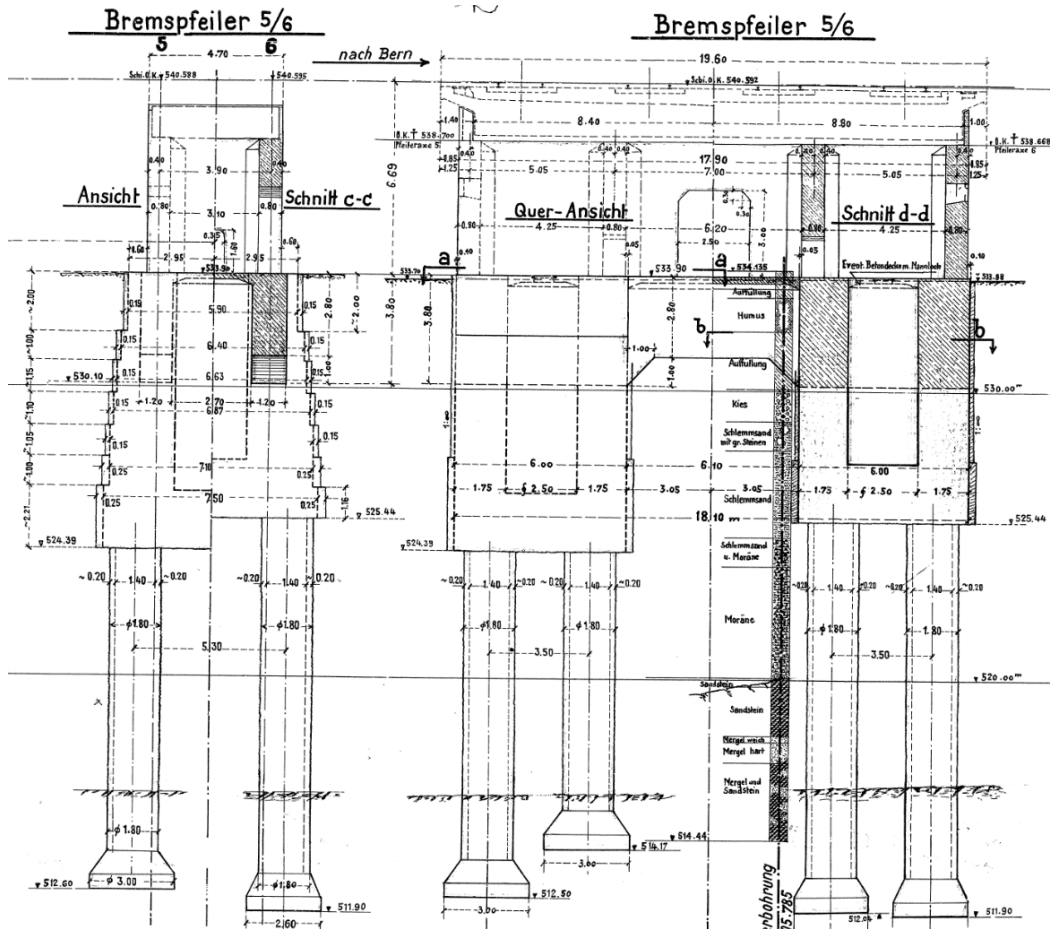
Bestehender Brückenpfeiler Unterbau in den zwei Ansichten (Ausschnitt aus Bestandsplan 17.107-16)
